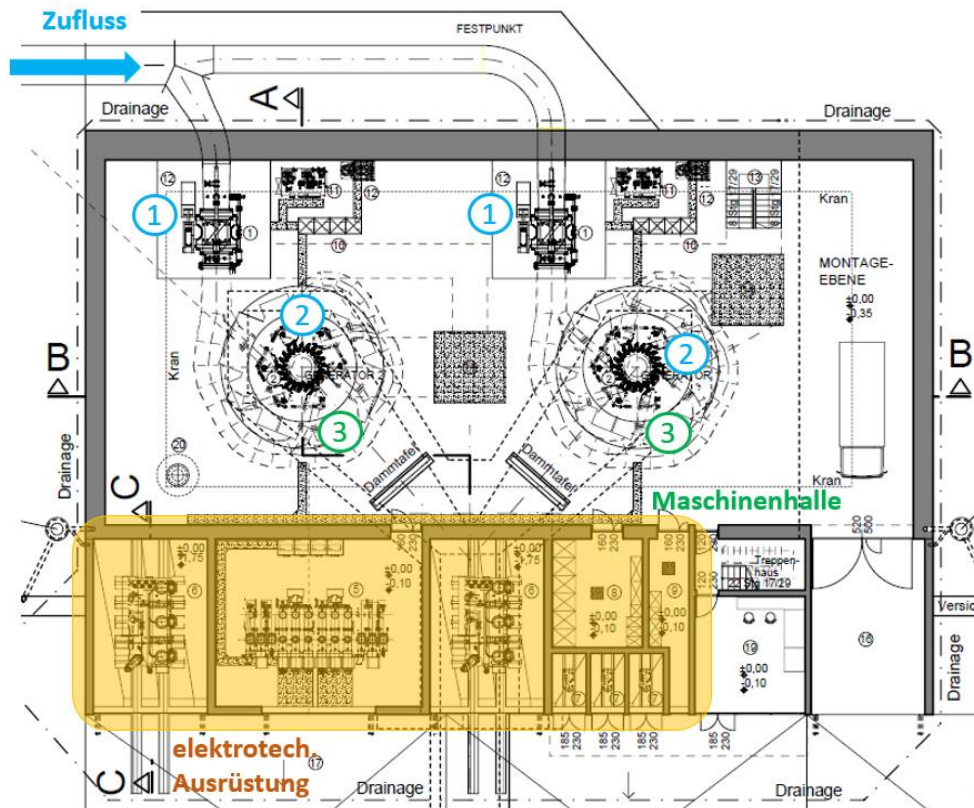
Grundriss Krafthaus Mitteldorf, WKW Obere Isel (Dr. Krauss ZT GmbH 2012)
